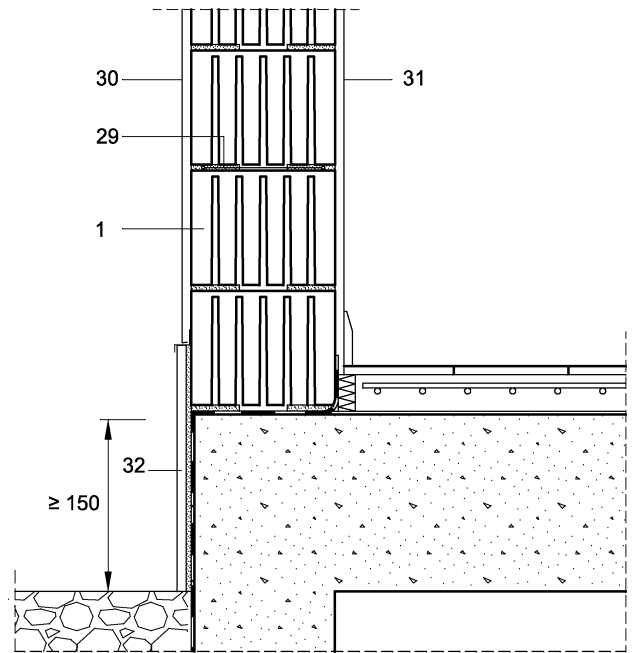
Arranque de muro sobre muro de cimentación.
